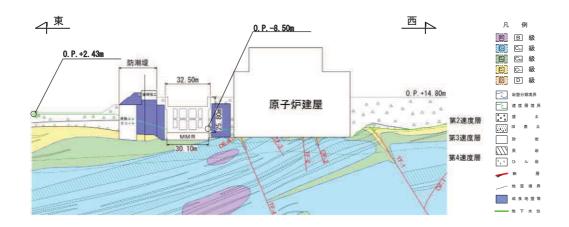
海水ポンプ室 地震時荷重算出用地質断面図 (A-A 断面, 東西 (スクリーンエリア))
